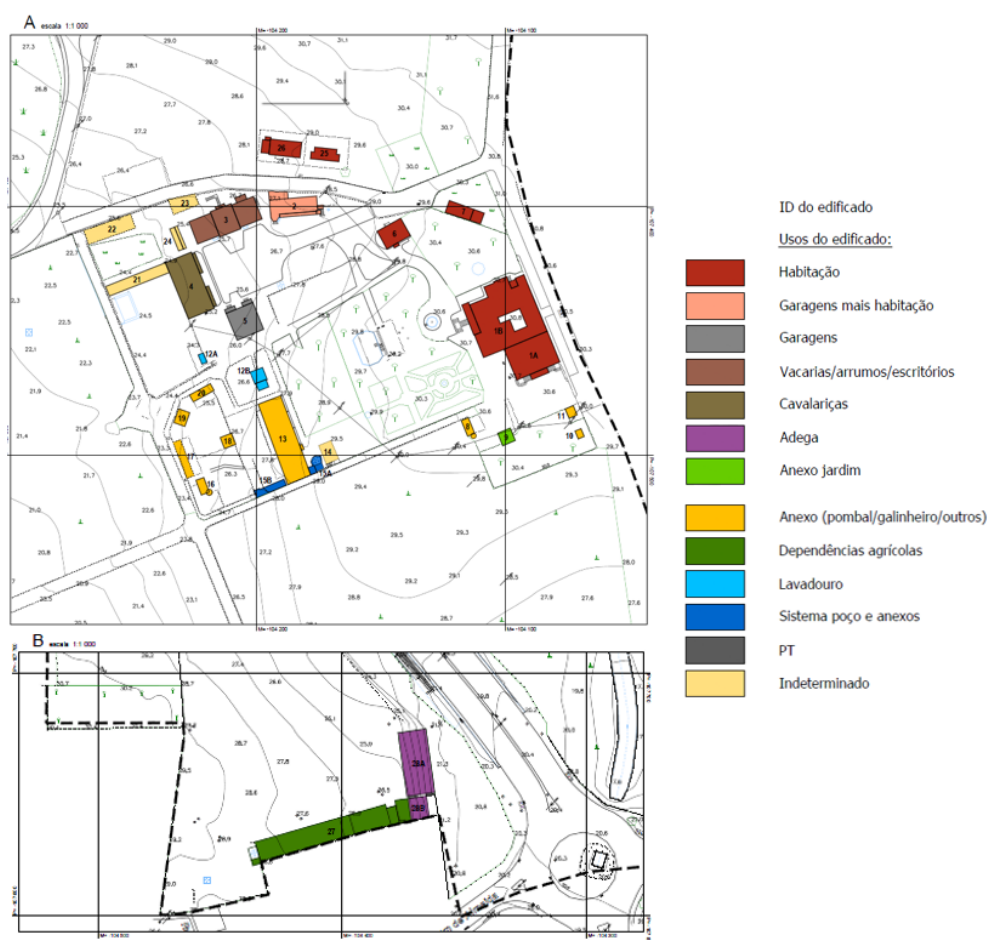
Planta de edificado existente na Quinta do Barão e seu tipo de uso (adaptado de NRV, 2021a)
